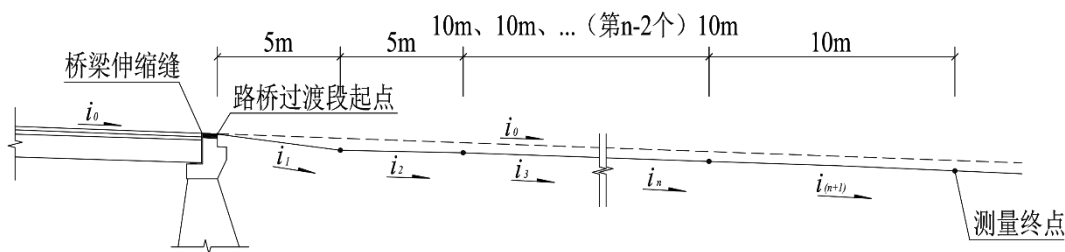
桥头设搭板时纵坡测量断面示意图
